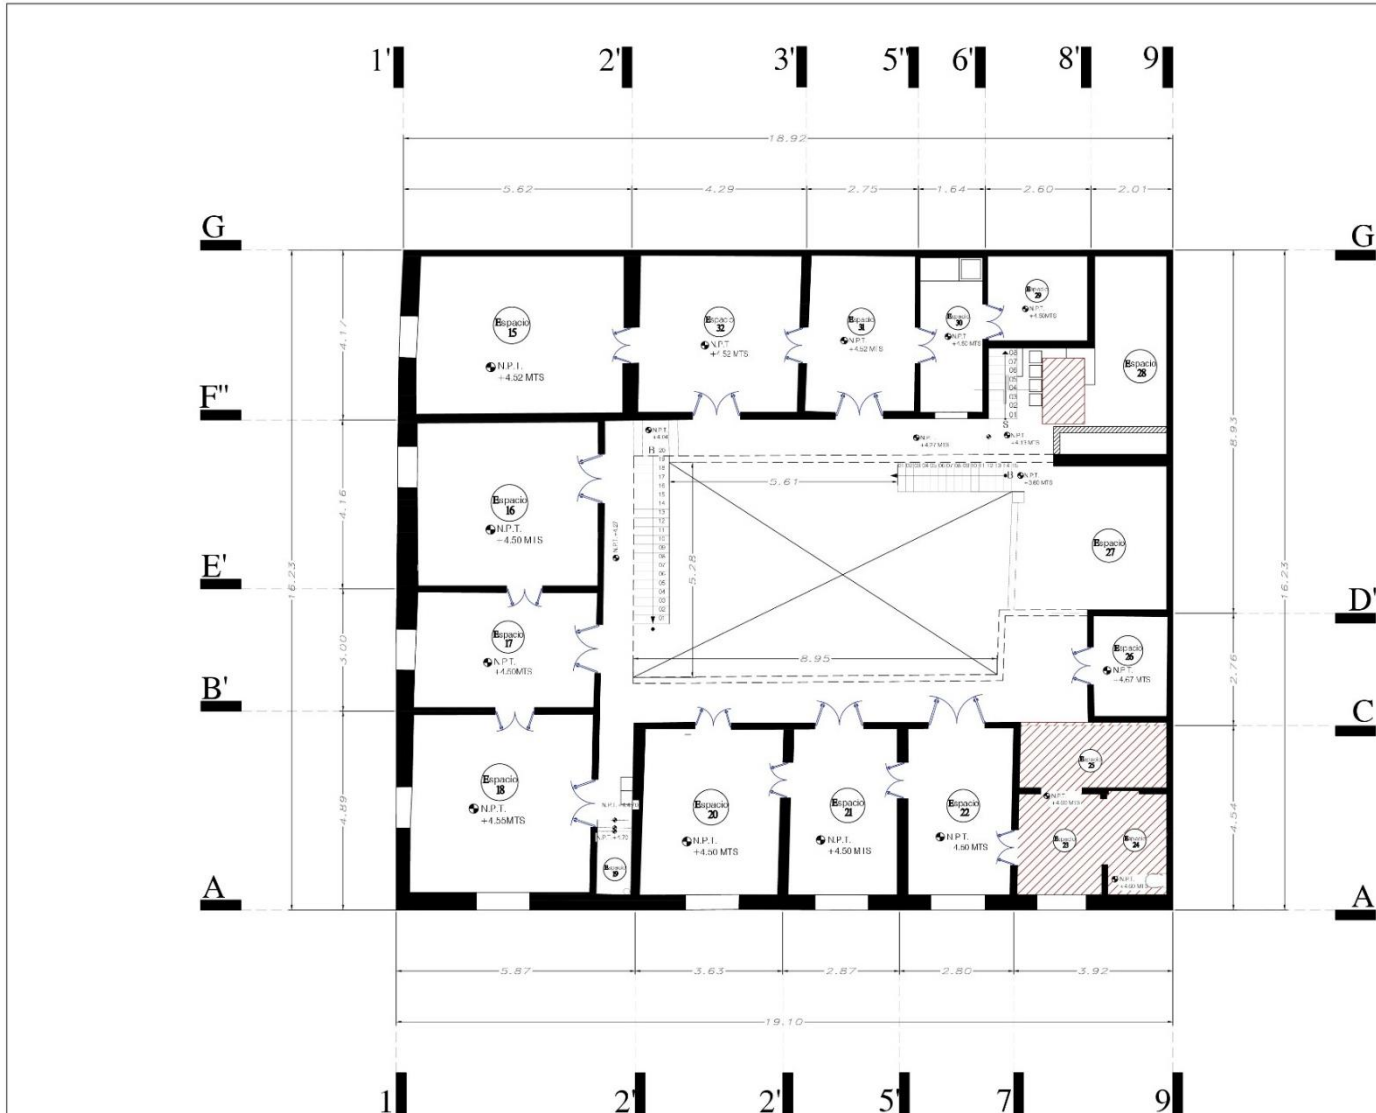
Plano de Planta Alta, variables de funcionamiento.
